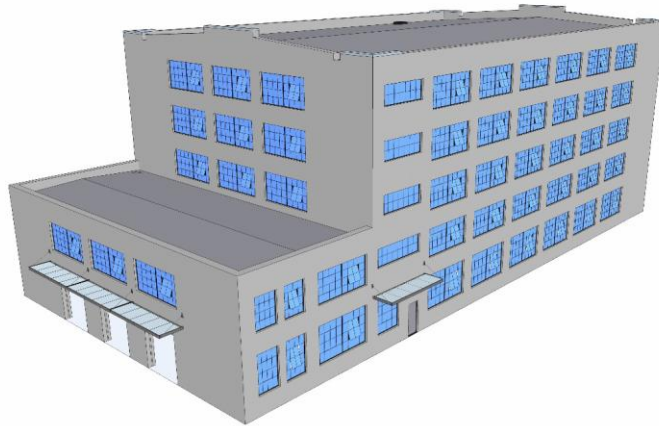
Ilustrasi bangunan dengan lantai dasar lemah karena perbedaan tinggi lantai
